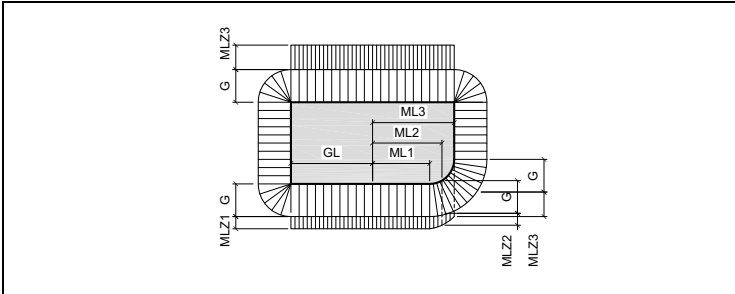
Grenzabstand bei gestaffelten Fassaden (§§ 21–26 ABV)
